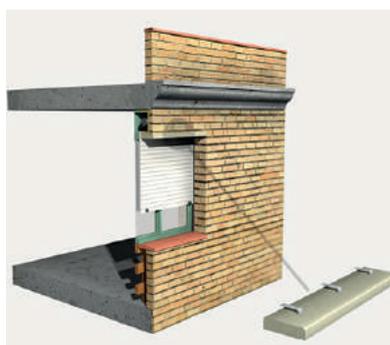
Cargadero prefabricado de hormigón. CYPE Ingenieros, S.A. www.generadordeprecios.info
